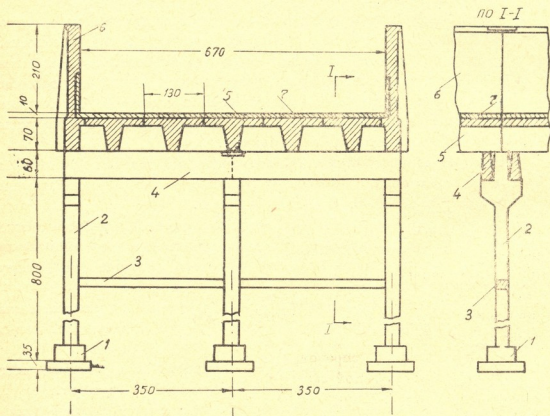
Продольный и поперечный разрезы селеспуска из сборного железобетона:
